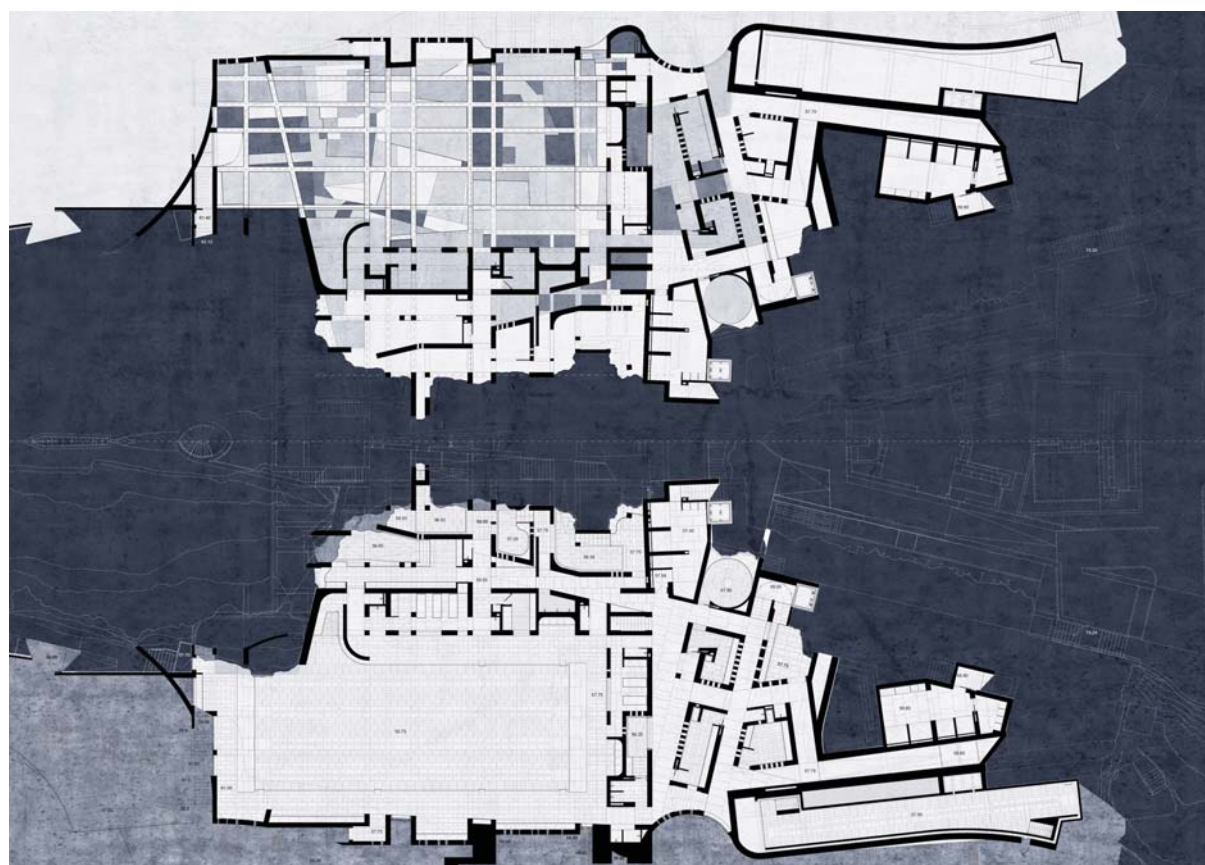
Planta de tetos e pavimento da piscina de principal (25 m): Contexto topográfico. 1:120.
